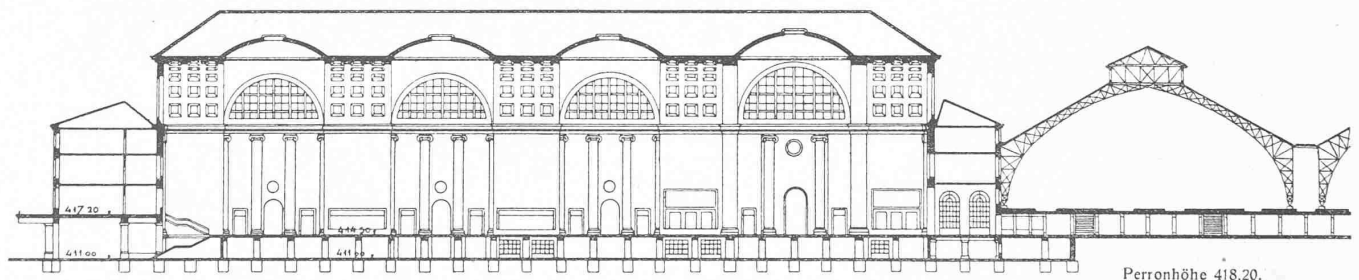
Längsschnitt durch Haupthalle und Zugangstunnel und Querschnitt durch die erste Geleischalle des Durchgangsbahnhofs. — Masstab 1:1000. [ ]
